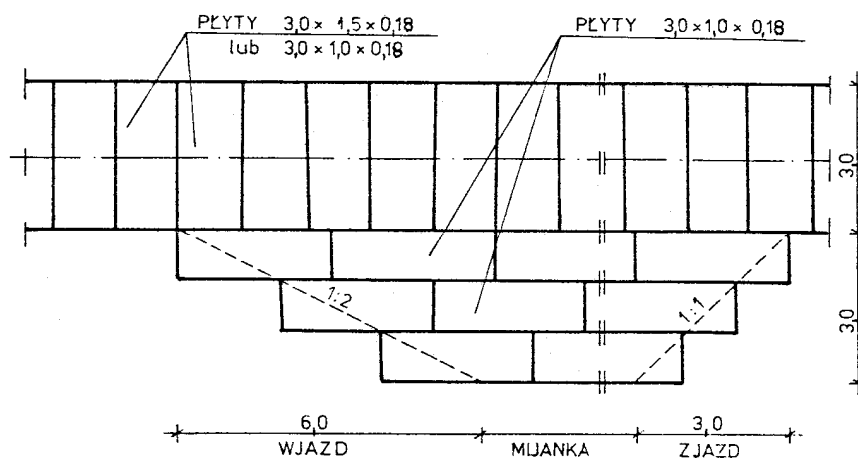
Przykładowy przekrój poprzeczny nawierzchni z płyt
